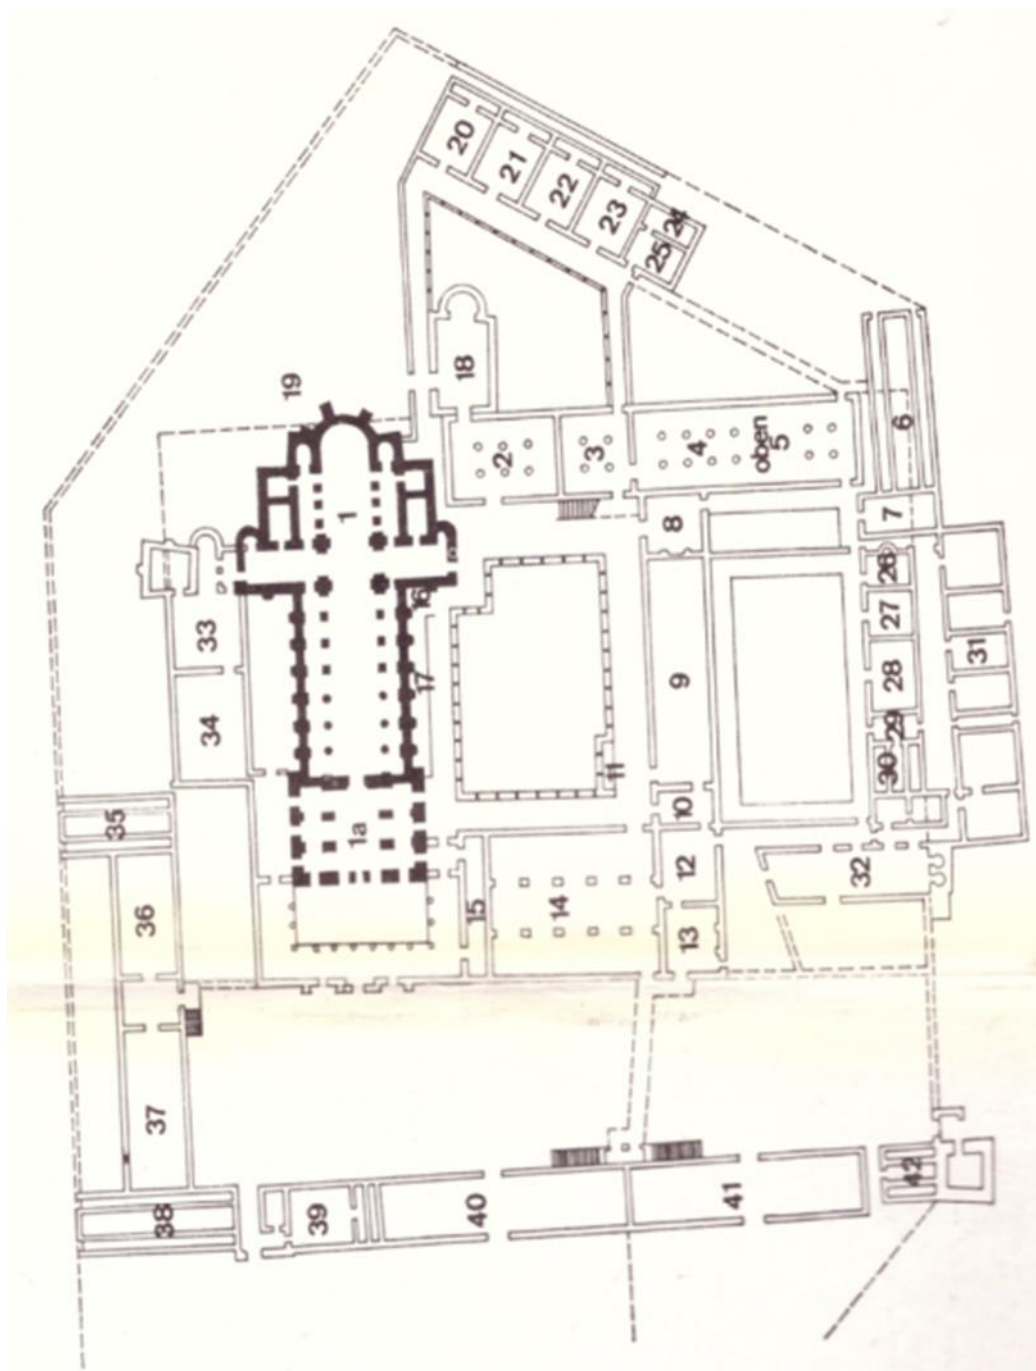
Plano de Cluny II (c.a. 1043): 1. Iglesia monástica. 1a. Galilea. 2. Sala capitular. 3. Locutorio. 4. Sala de los monjes, planta baja. 5. Dormitorio, planta noble. 6. Letrinas. 7. Baños. 8. Calefactorio. 9. Refectorio. 10. Sala de Aliño. 11. Pabellón de la fuente. 12. Cocina de los monjes. 13. Cocina de los legos. 14. Cilla. 15. Sala del pobrero. 16. Librería. 17. Lugar de trabajo de los amanuenses. 18. Capilla de santa María. 19. Camposanto. 20-23. Noviciado. 24. Baño (?). 25. Sala del médico. 26-30. Noviciado. 31. Talleres. 32. Tahona. 33. Sacristía. 34. Talleres del sastre y zapatero. 35. Letrina para mujeres (?). 36. Hospedería para mujeres. 37. Hospedería para hombres. 38. Letrinas para hombres. 39. Hospicio para pobres. 40-41. Establos y dormitorios de conversos. 42. Letrinas para conversos. Extraído de: W. Braunfels, *Arquitectura monacal en occidente*, Barcelona, Seix Barral, 1975.
